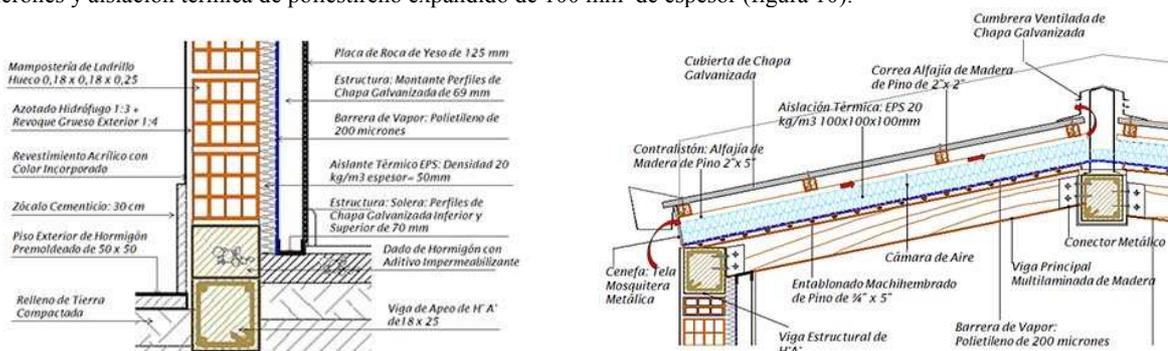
Características constructivas de muros y cubierta de la vivienda categoría 3 y 4
